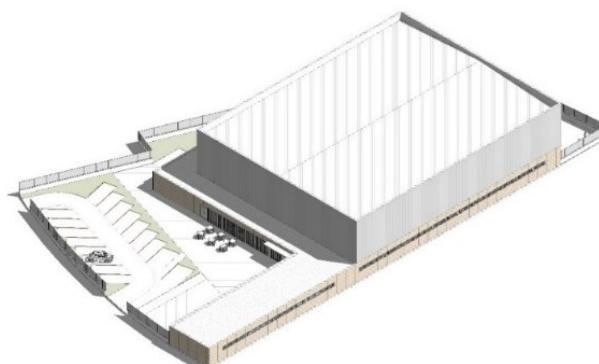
ESTRUCTURA PABELLÓN DEPORTIVO
